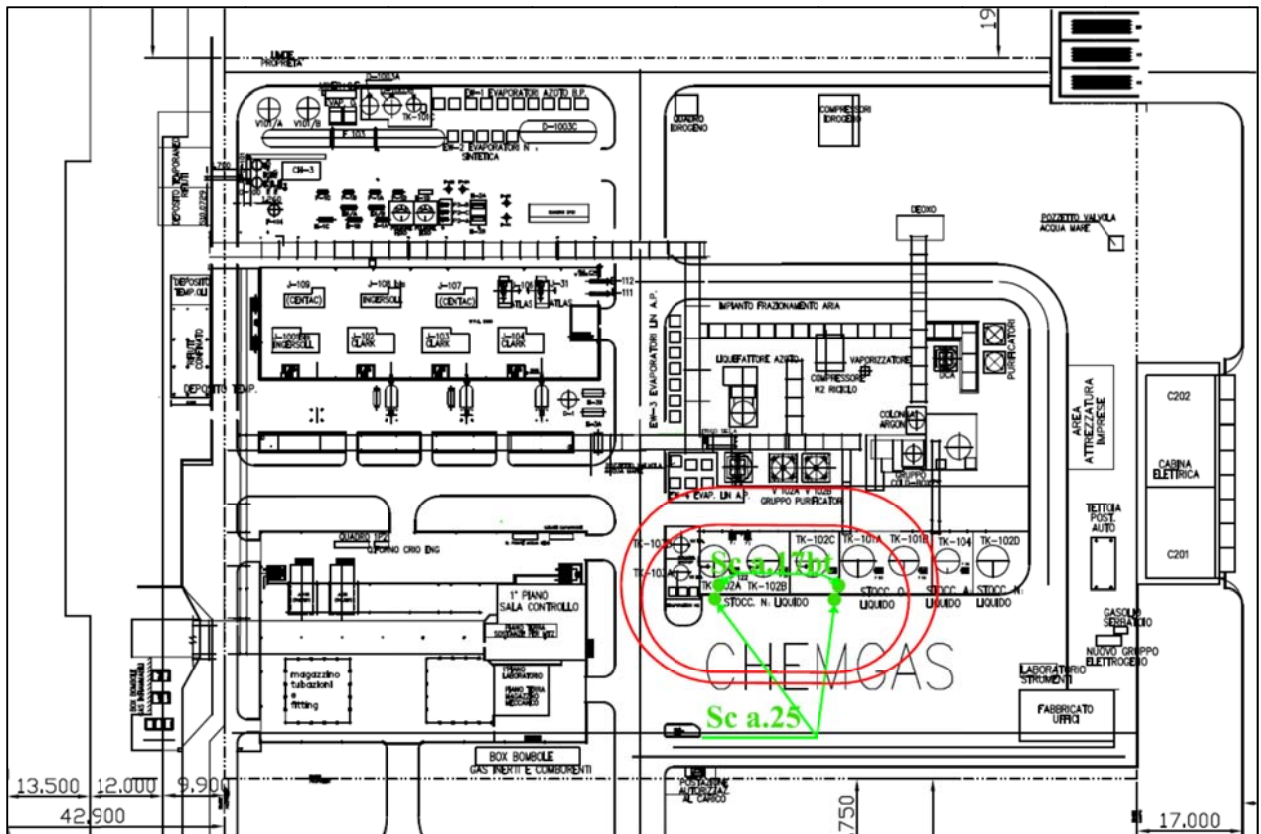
Stralcio della Planimetria limiti proprietà impianto – Dispersione Azoto Rottura Parziale D5
